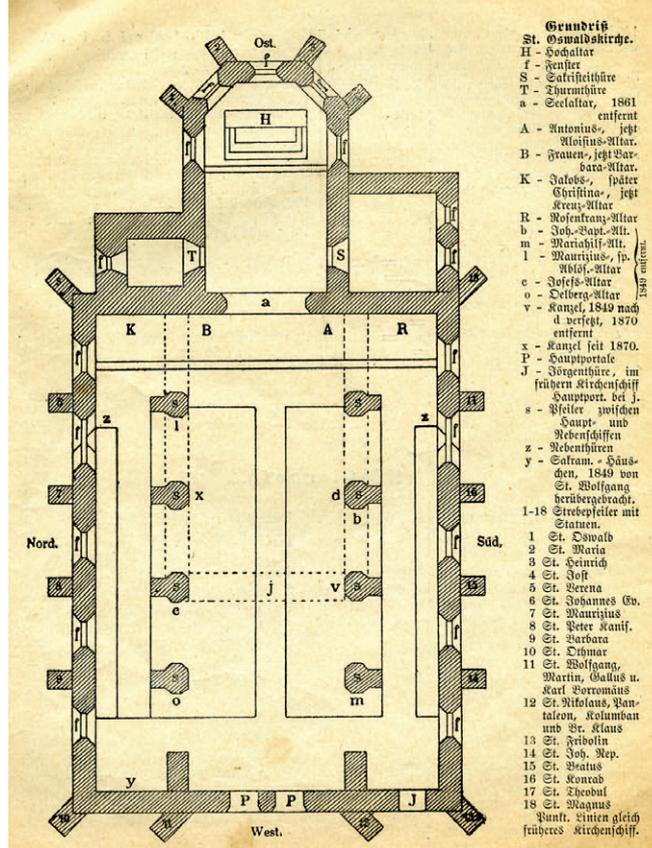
Zug, Kirche St. Oswald. Schematischer Grundriss mit Standort aller Altäre vor 1850 und der Bauskulptur um 1890.
